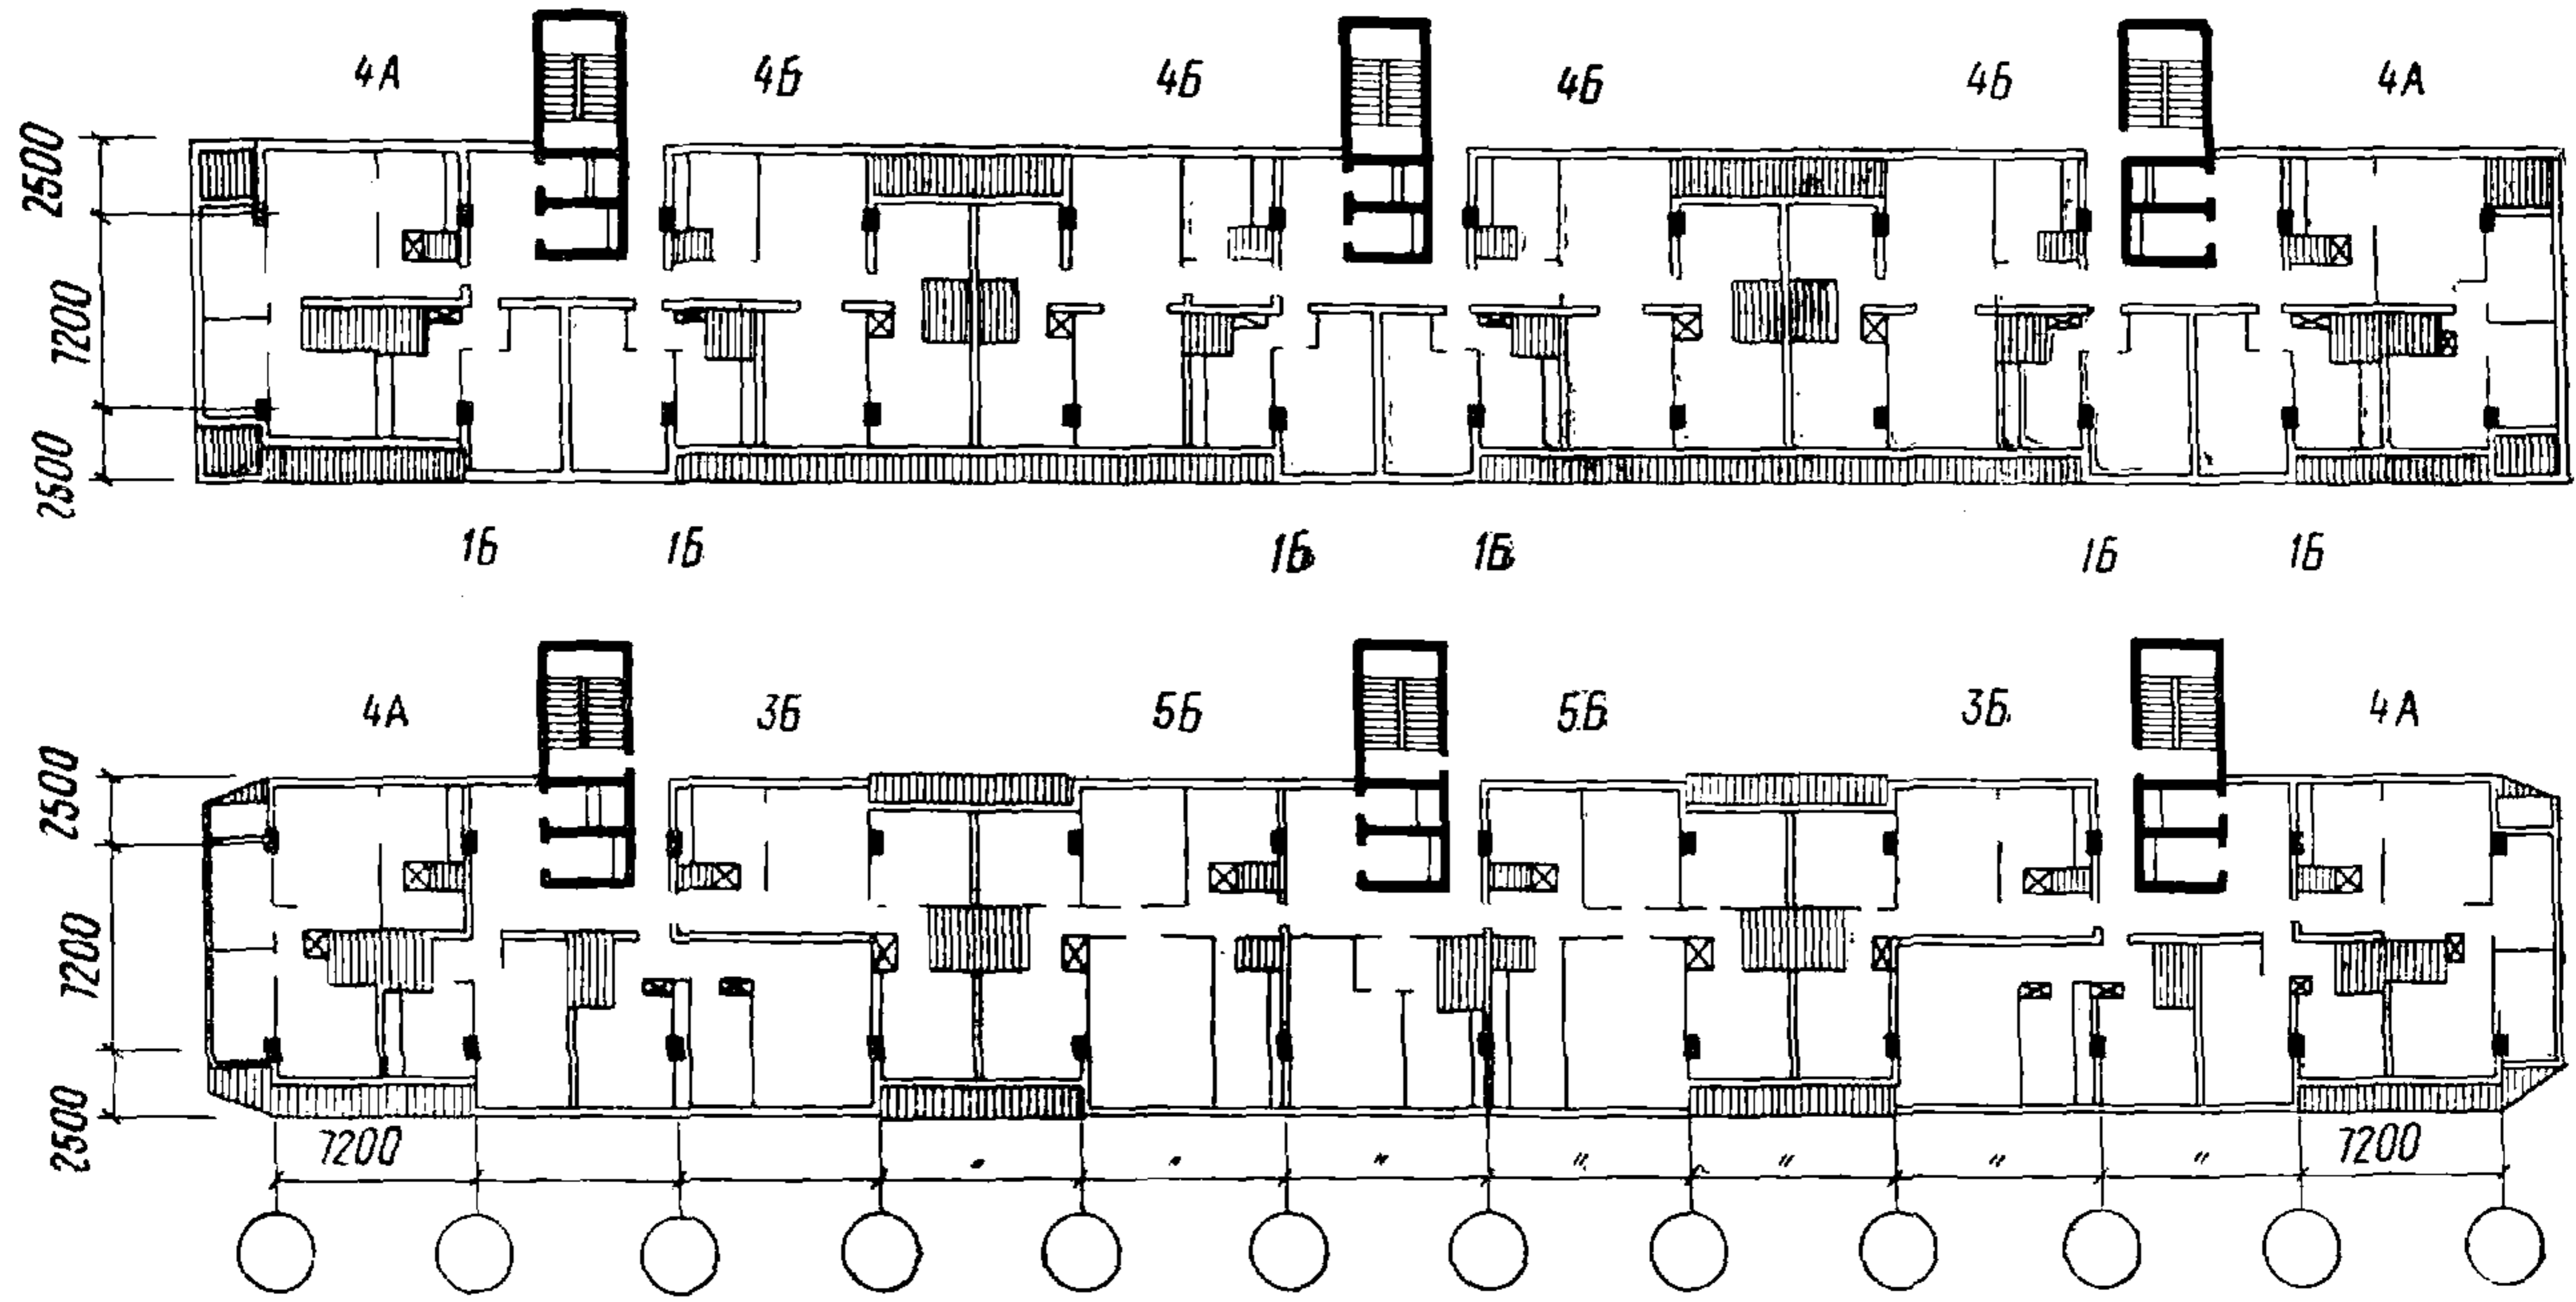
Варианты планировки квартир 16-этажного жилого дома со встроенным магазином в первом этаже (ЛенЗНИИЭП)
